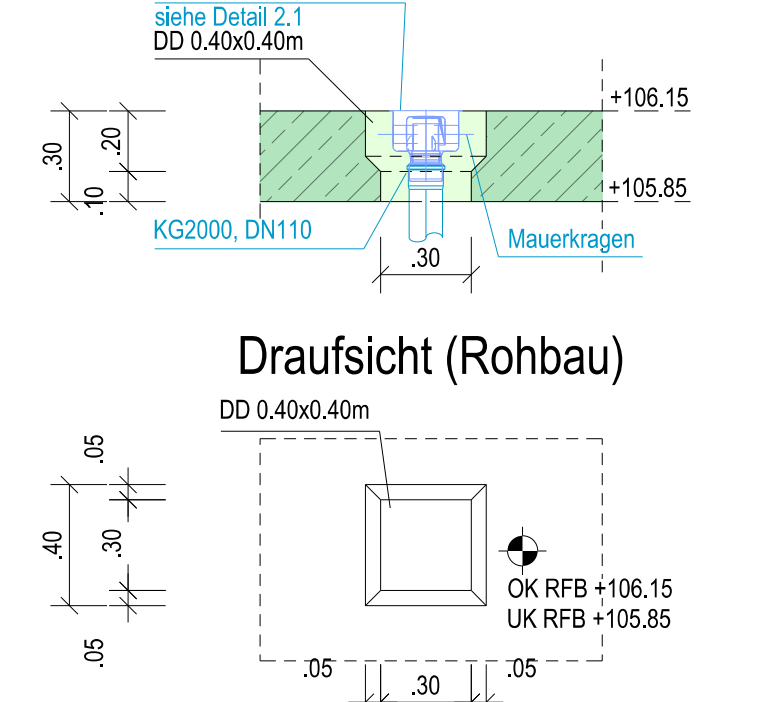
, Deckendurchbruch 1 (DD1, Bodenablauf)
